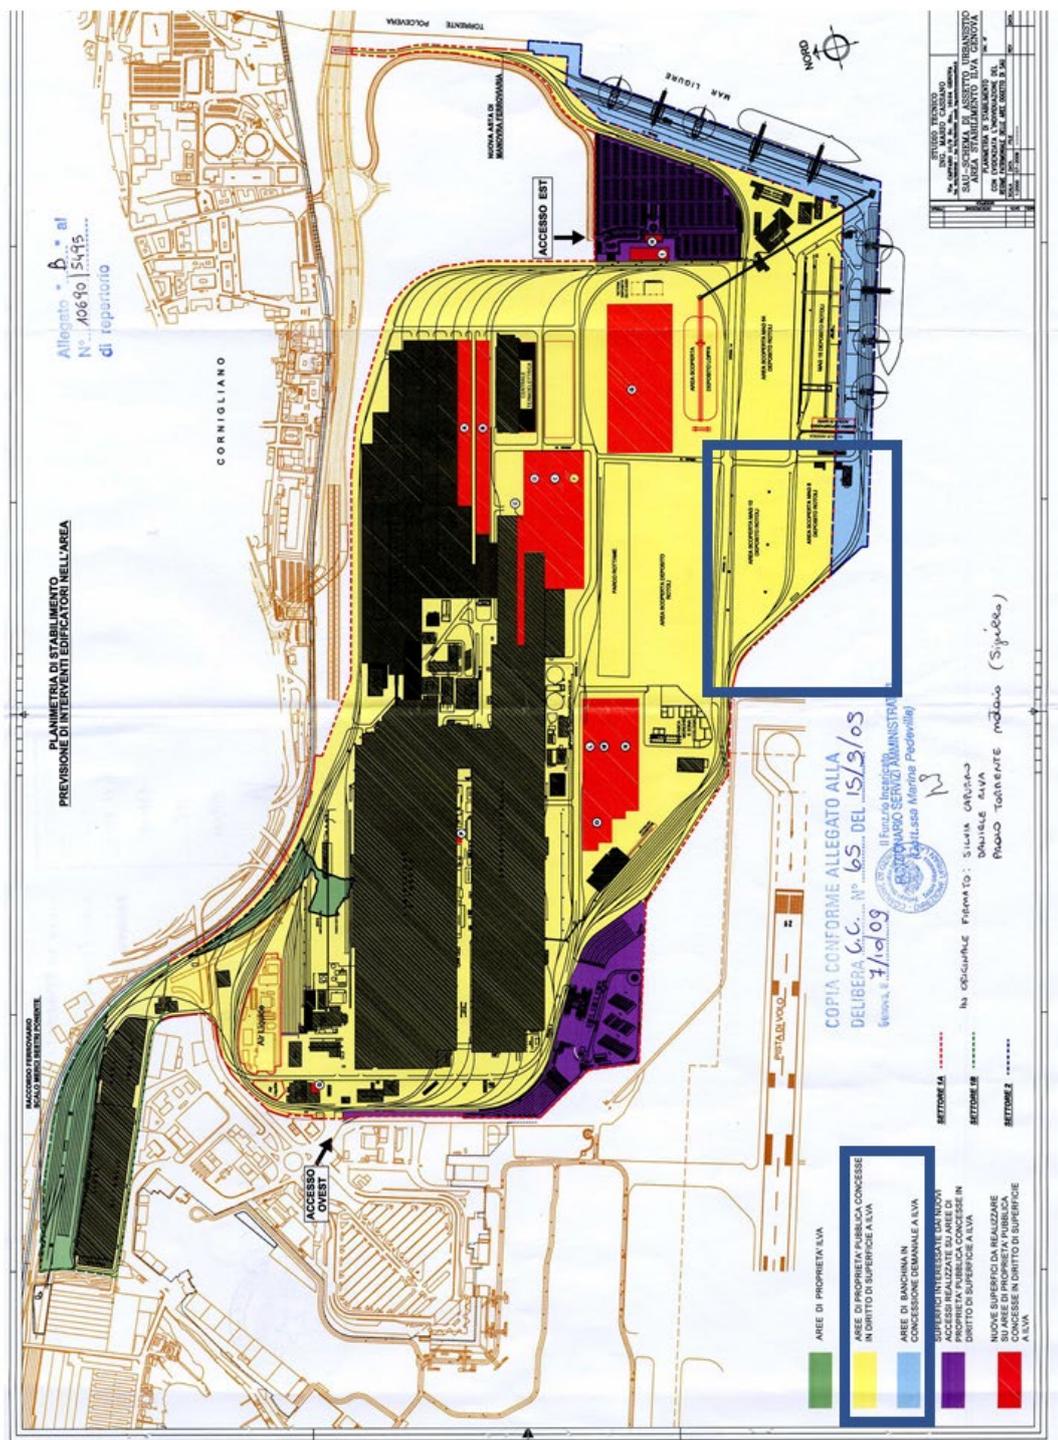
AREA EX ILVA – PLANIMETRIA DELLE AREE OGGETTO DI SAU
